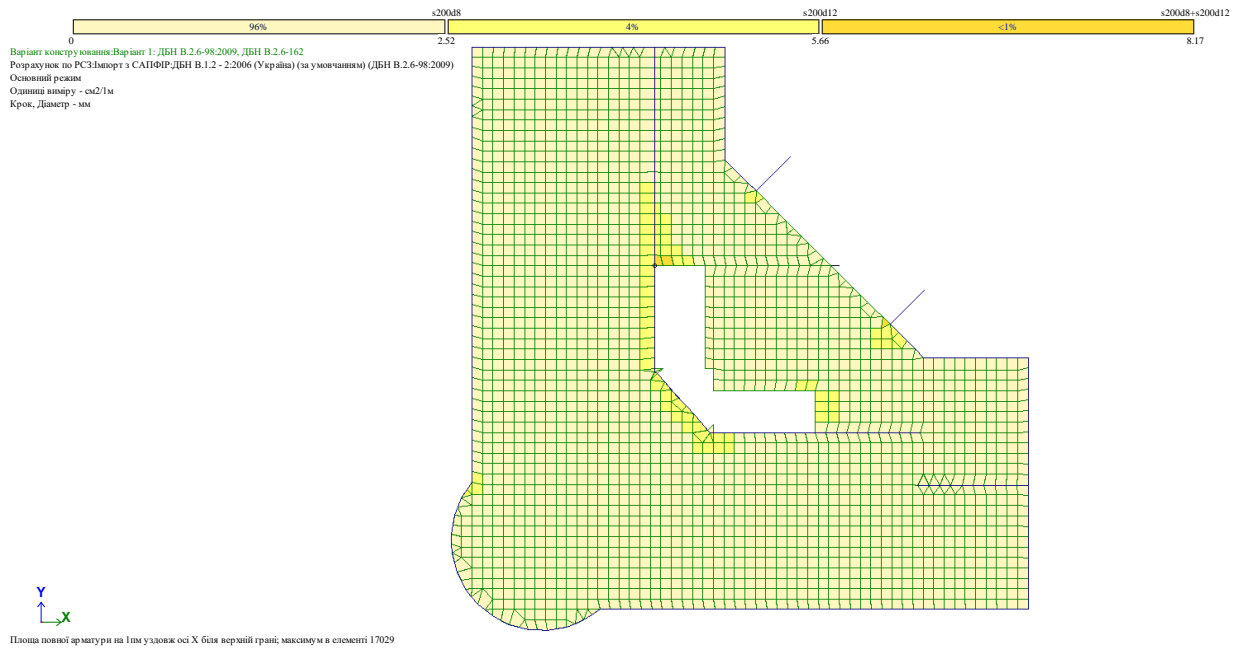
Площа повної арматури на 1м уздовж осі X біля верхній грані для плити перекриття 2-го поверху
